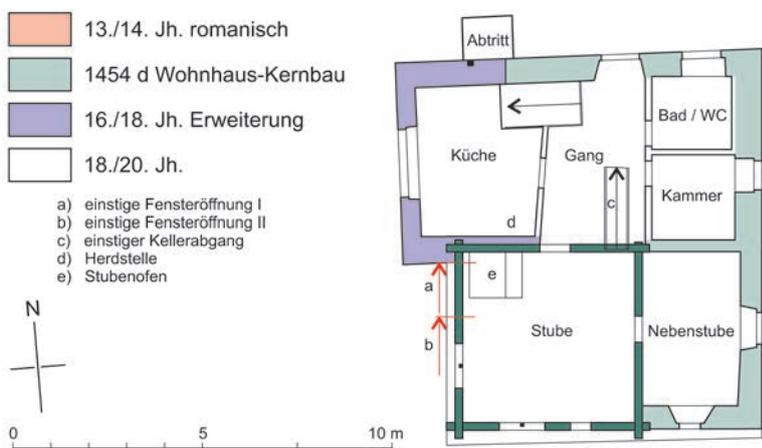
Grundriss Erdgeschoss. M. 1:200.
